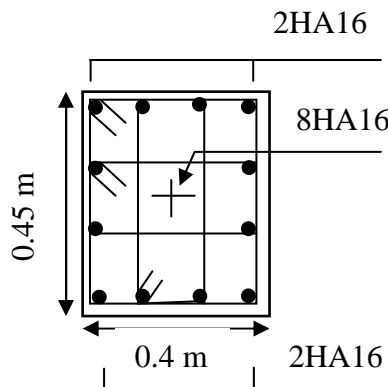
Schéma de ferrailage des poteaux rectangulaires de section (40 X 45) Cm².
